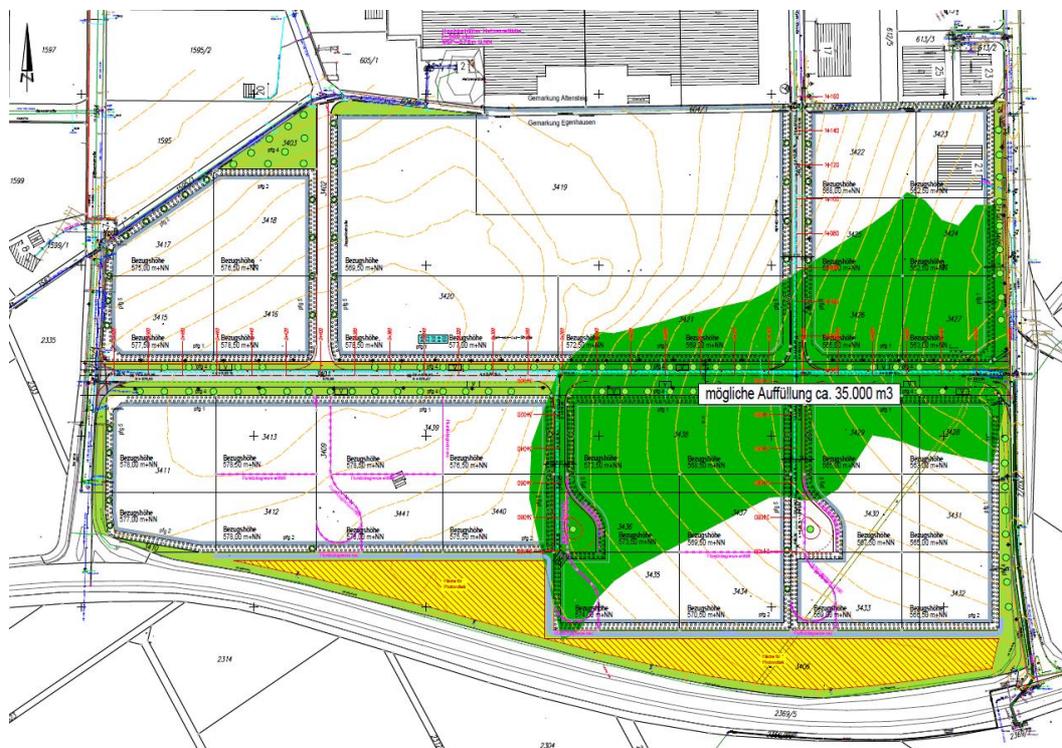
Lageplan mögliche Flächenauffüllung [3], unmaßstäblich
